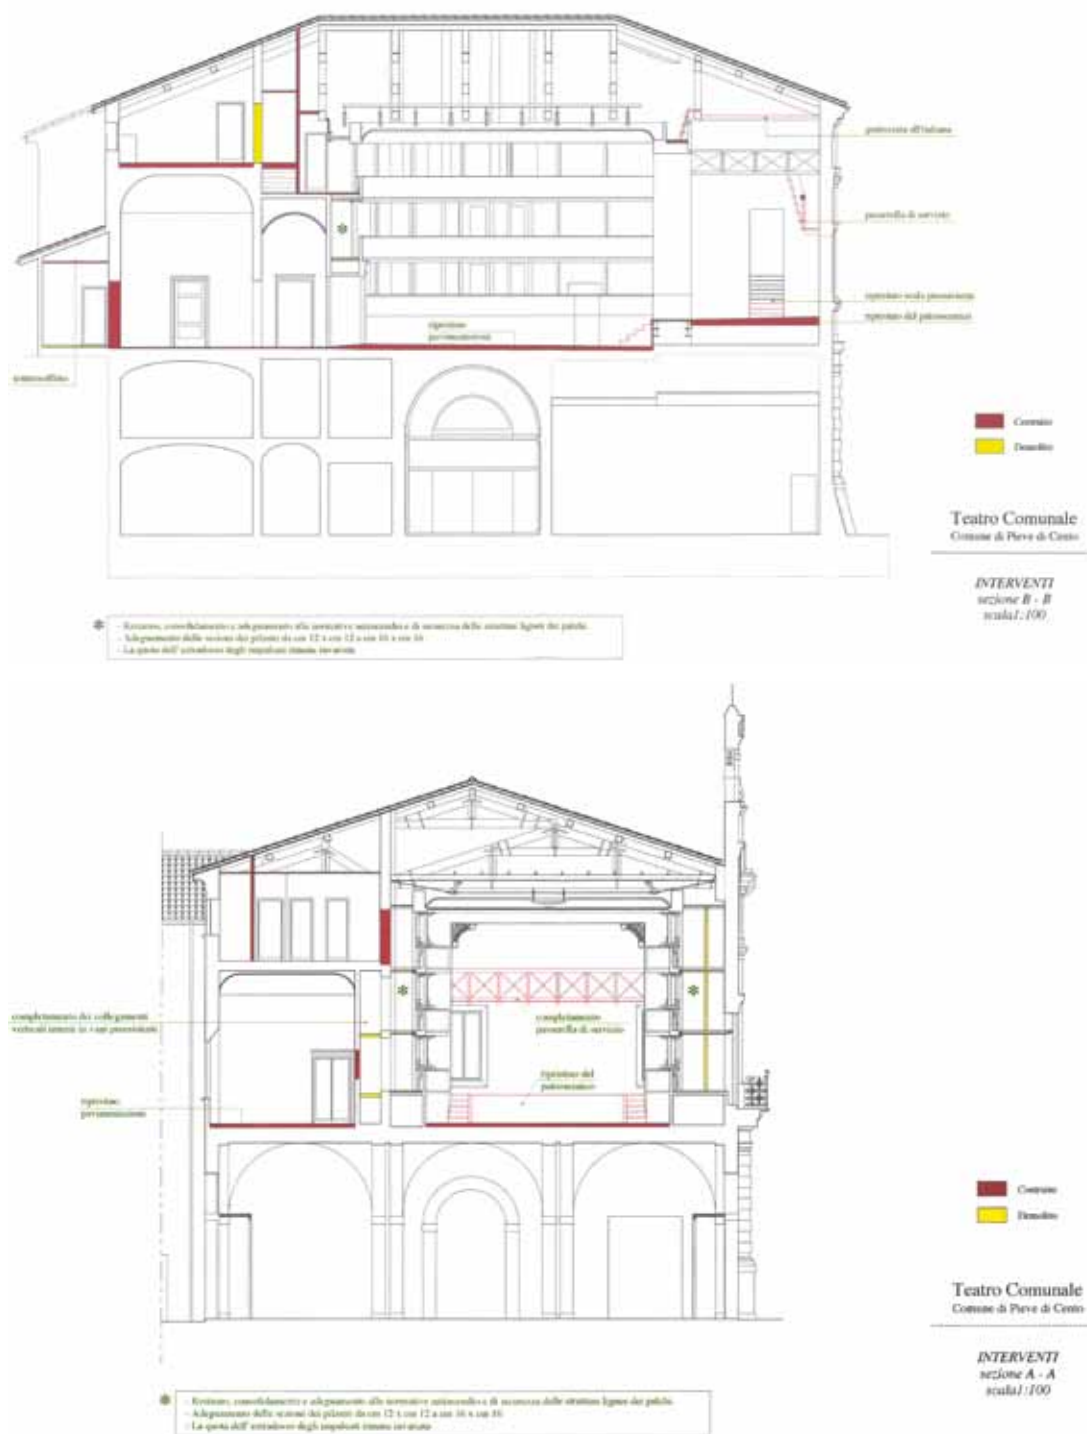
Restauri degli anni Ottanta, sezioni trasversale e longitudinale. Si osservi la soluzione, probabilmente originaria, di sospensione delle centine del plafone rispetto alle capriate di copertura (A.U.T.P.Ce. Revisione del Progetto di restauro Conservativo del Teatro Comunale. Tavv. 3.1, 3.2).
